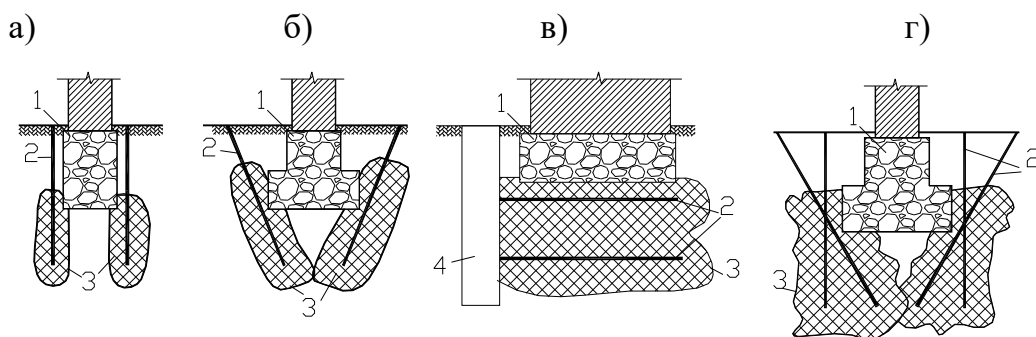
Схеми можливого розташування ін'єкторів при закріпленні основ: 1 – фундамент, 2 - ін'єктор, 3 - зона закріплення, 4 - шахта.
